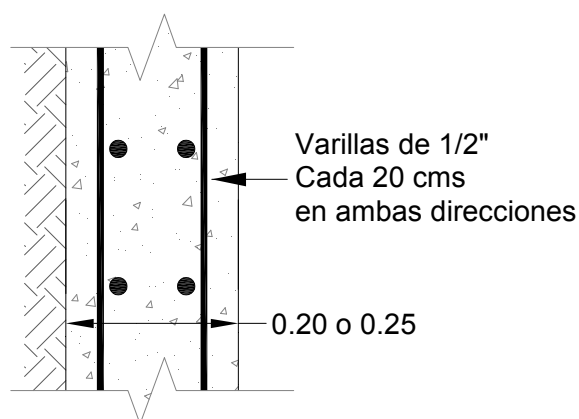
Detalle de corte Muro de cilindro del Pozo de Inspección
